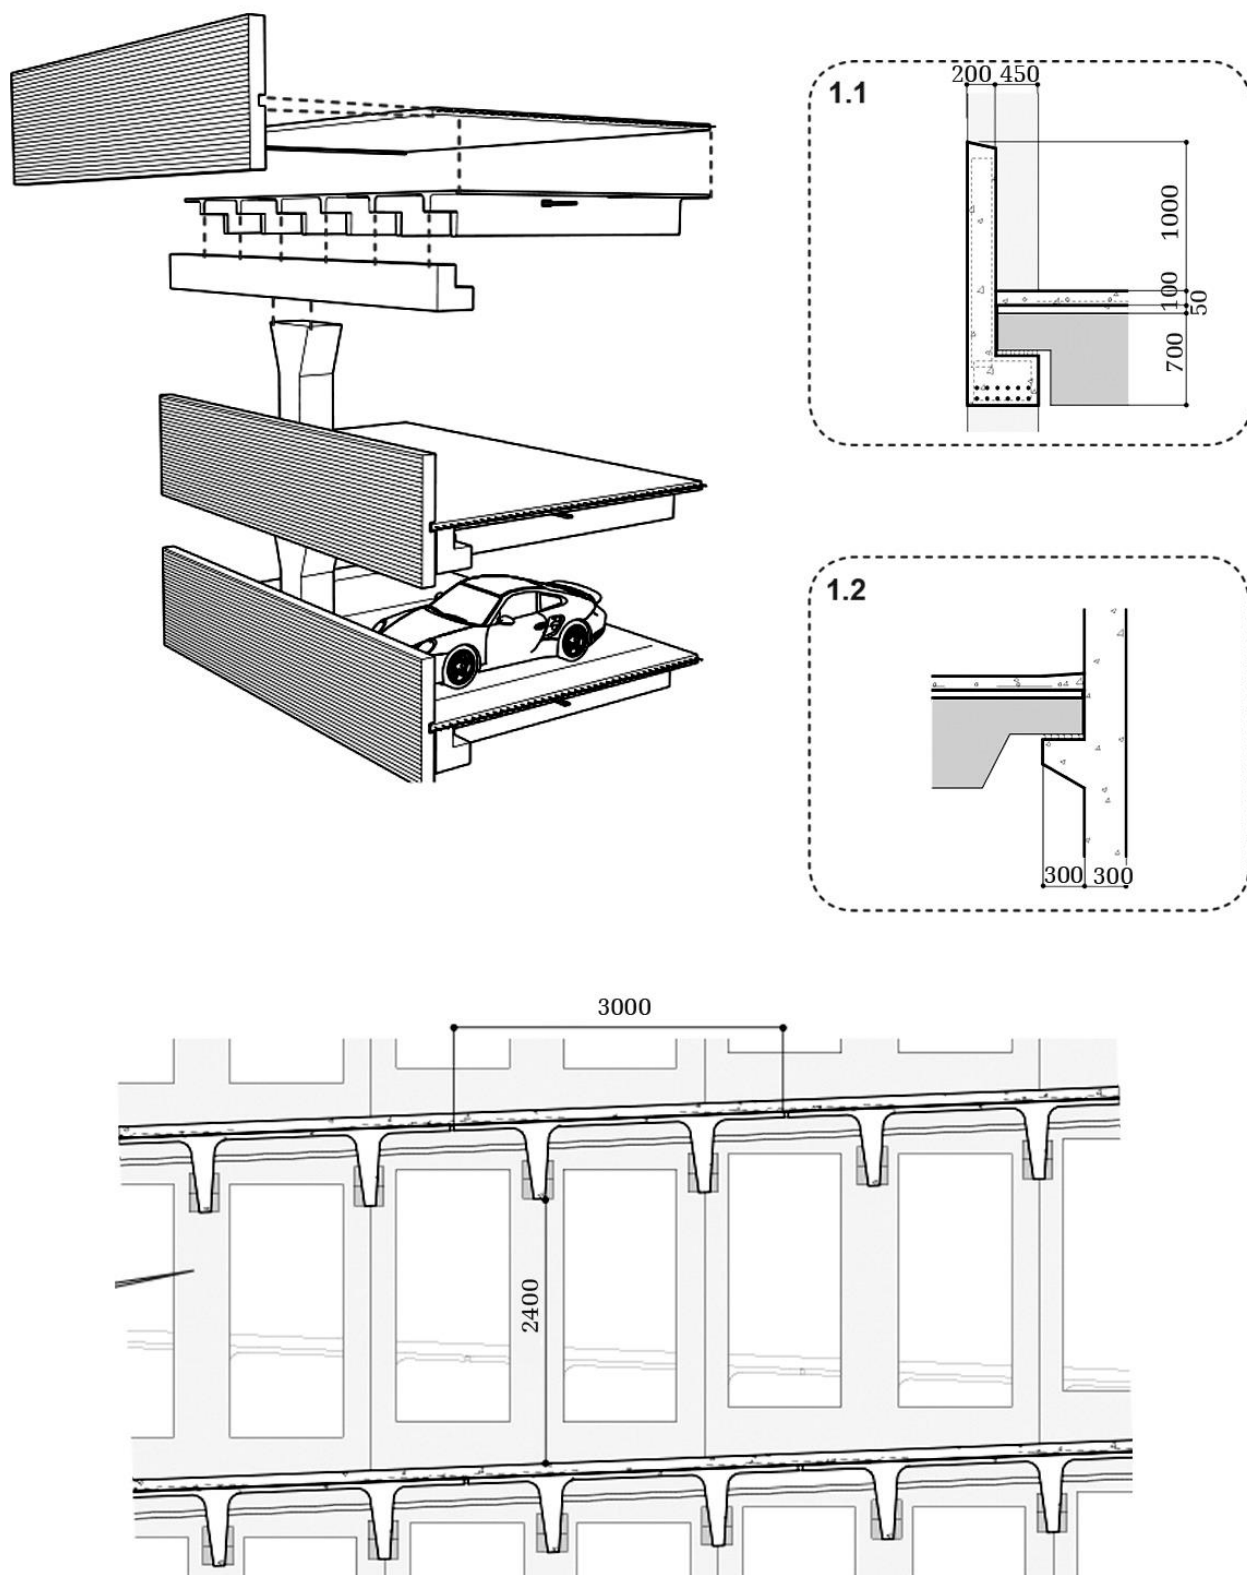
Схематичное изображение опирания ребристой плиты перекрытия на колонны.
